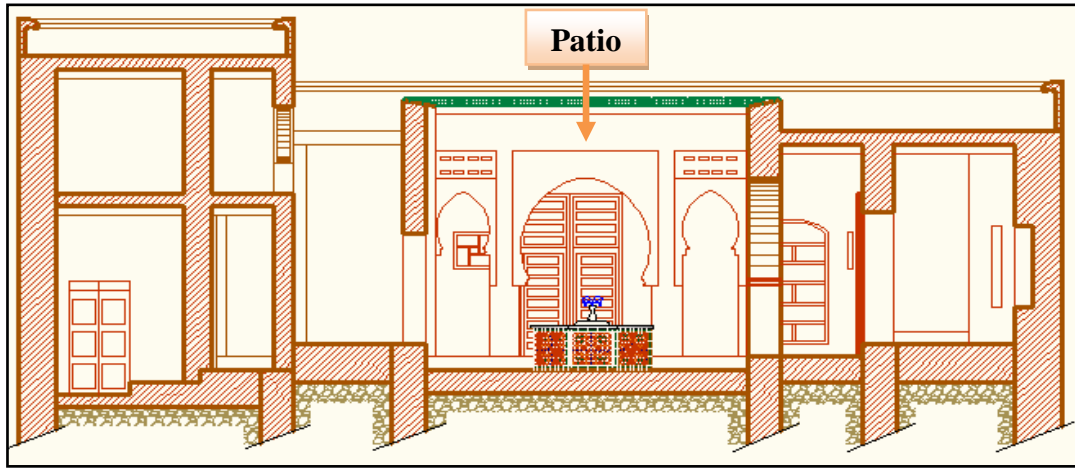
Coupe sur la maison. Source: Auteur.
